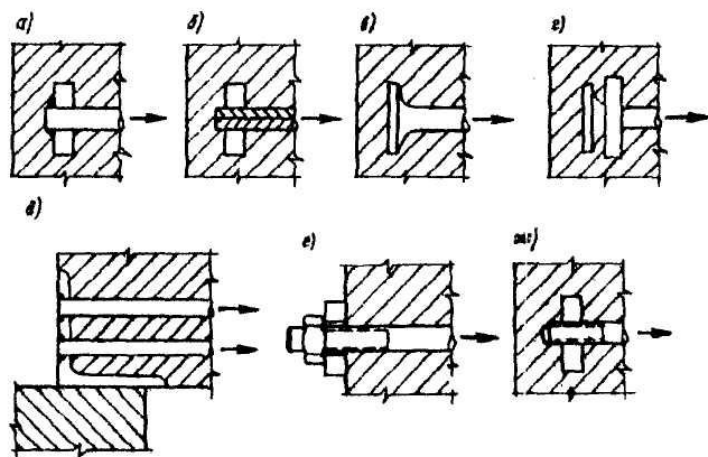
Анкеровка арматуры путем устройства на концах специальных анкеров, в виде: а - приваренной пластины; б - обжатой пластины; в - высаженной головки; г - высаженной головки с шайбой; д - приваренного стержня к уголку; е - гайки с шайбой снаружи; ж - гайки внутри
